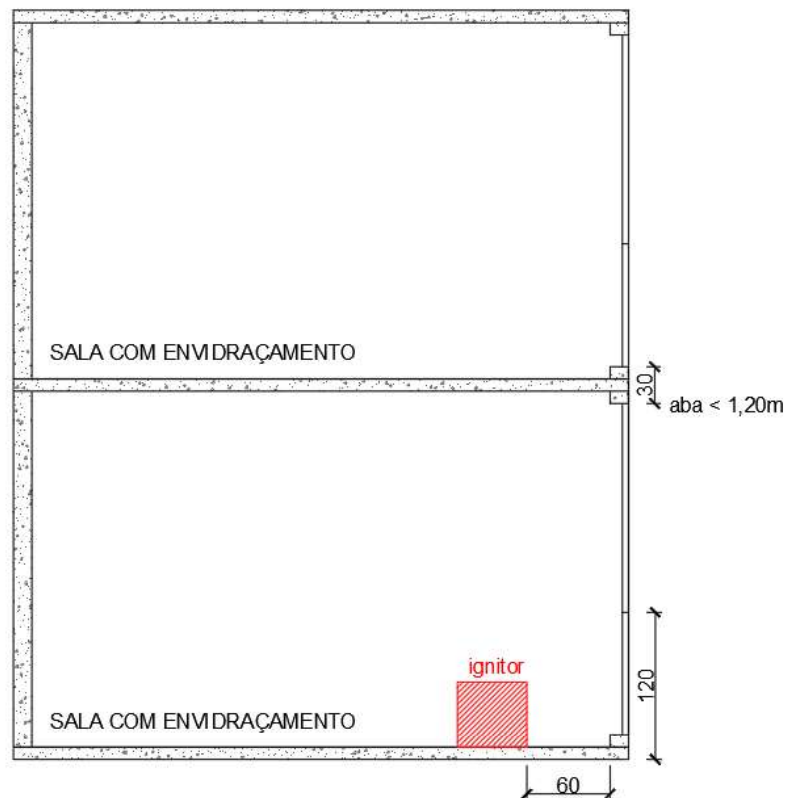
Planta baixa da edificação construída com envidraçamento de varanda para as simulações computacionais. Medidas em centímetros e sem escala. (Fonte: Autor)
